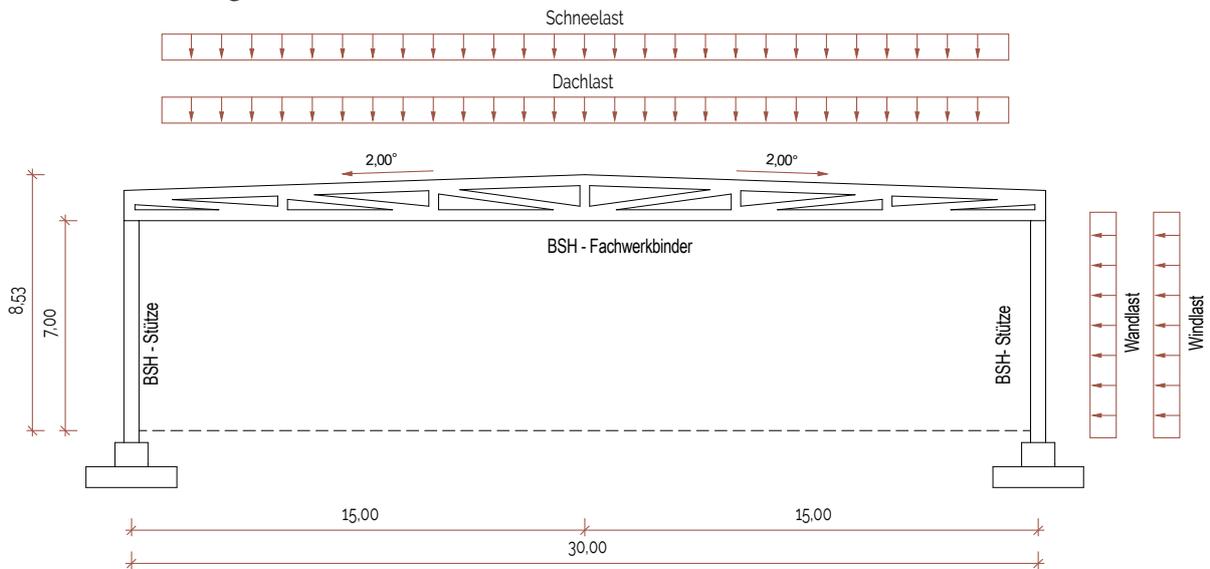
Schnitt BSH - Tragwerk (Fachwerk)
